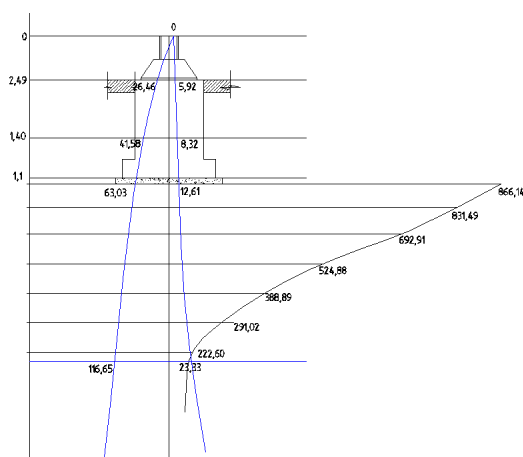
Определения осадки фундамента для крайней колонны
